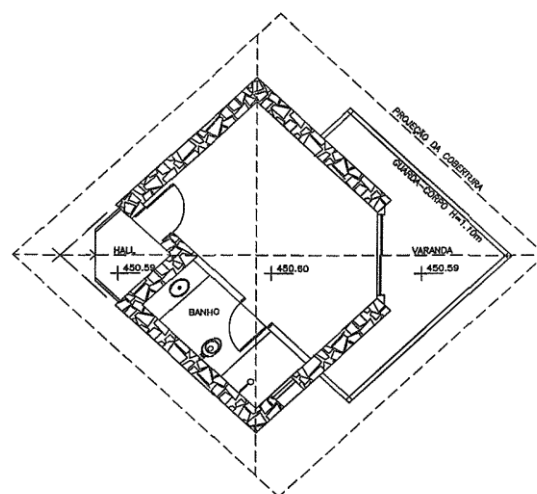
Planta do piso 1. Fonte: Município de Castanheira de Pêra.
